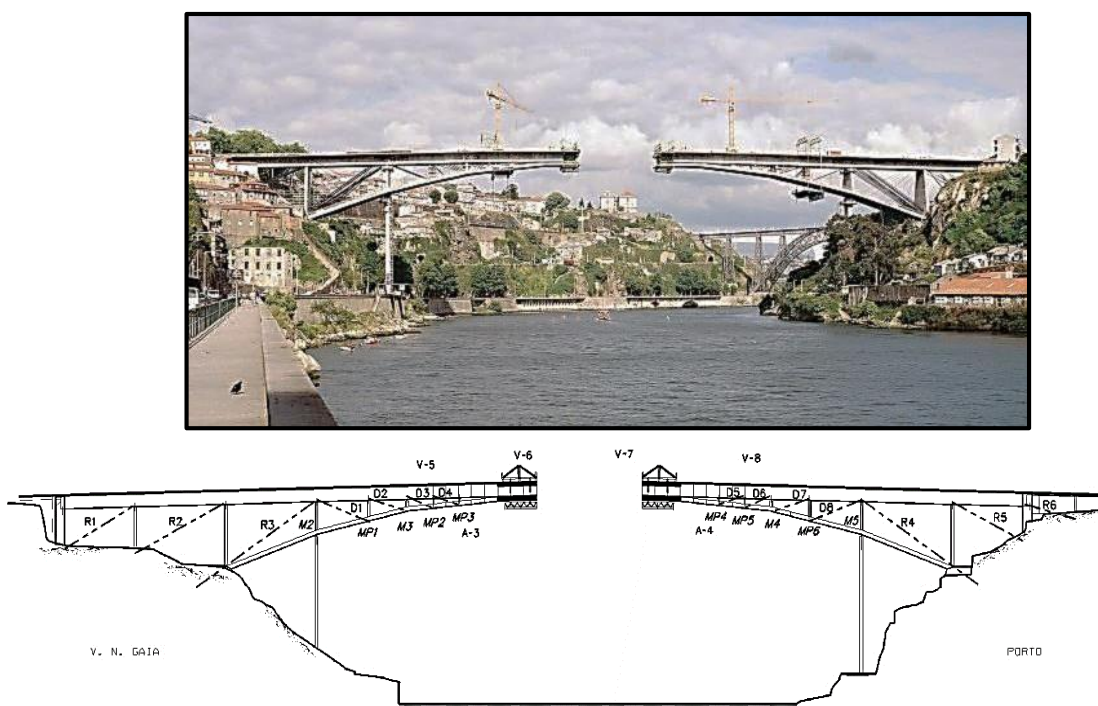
Sistema de triangulação na construção da Ponte Infante D. Henrique, Porto, Portugal.
